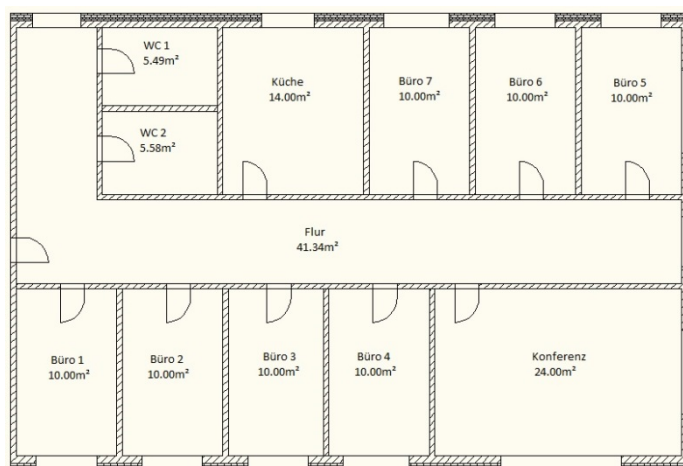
Grundriss des in TRNSYS abgebildeten Bürogebäudes
